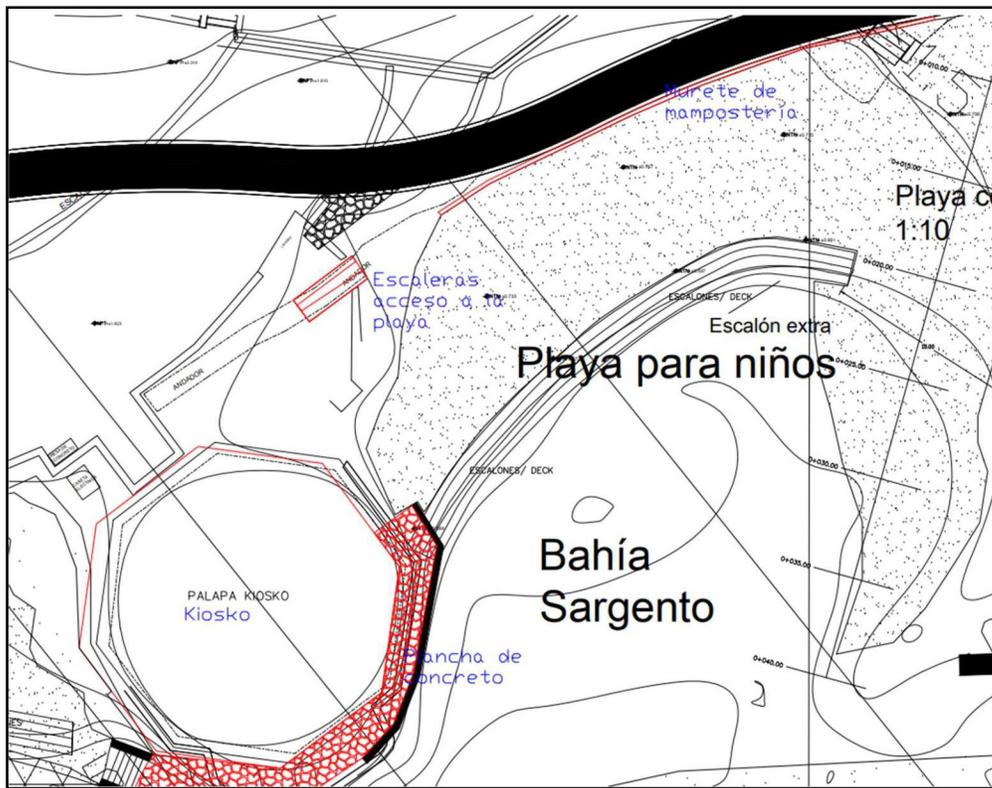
Ubicación de las obras sancionadas y que se pretende su regularización; localizadas entre la caleta Playa Sur y la Bahía Sargento (señaladas en color rojo). Extracto del Plano de conjunto.
